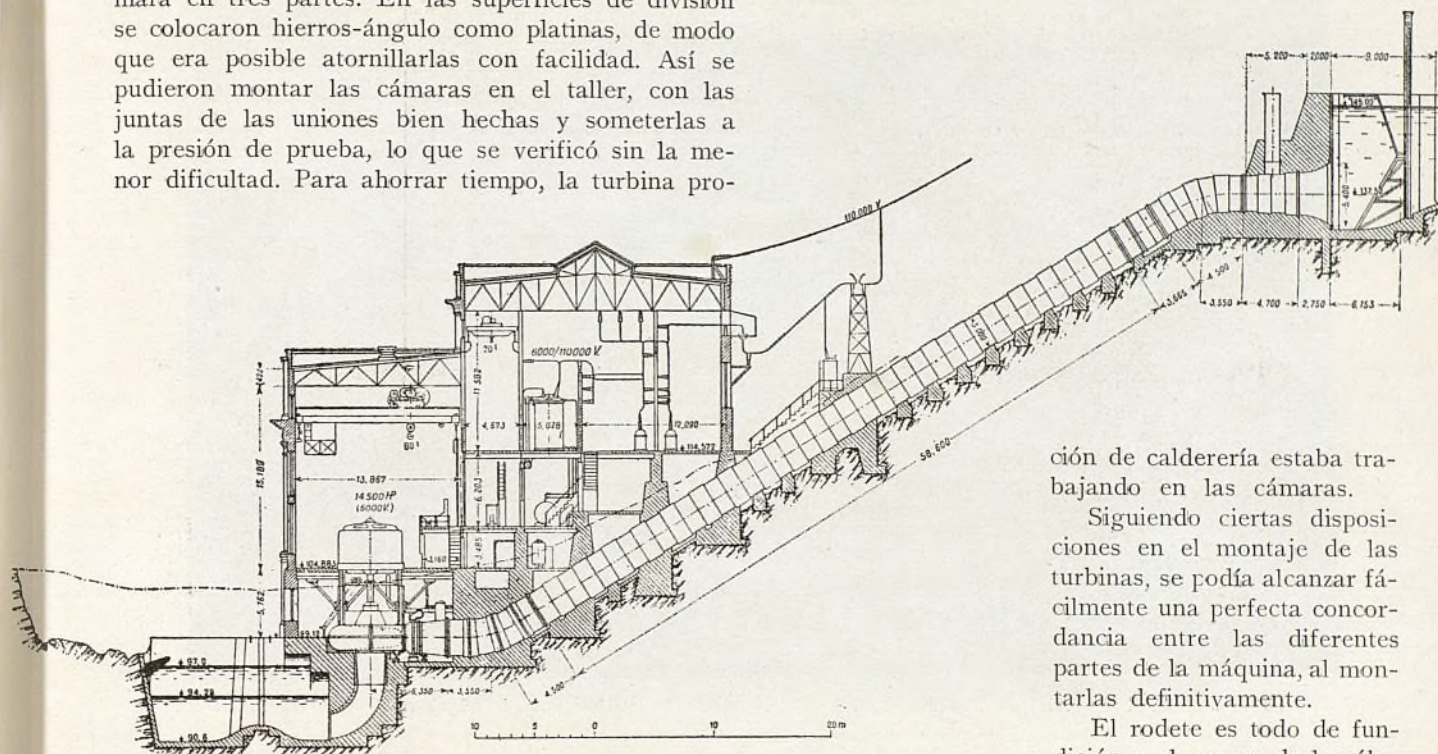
Corte de la casa de máquinas, tubería de presión y cámara de agua.—1 : 600.
